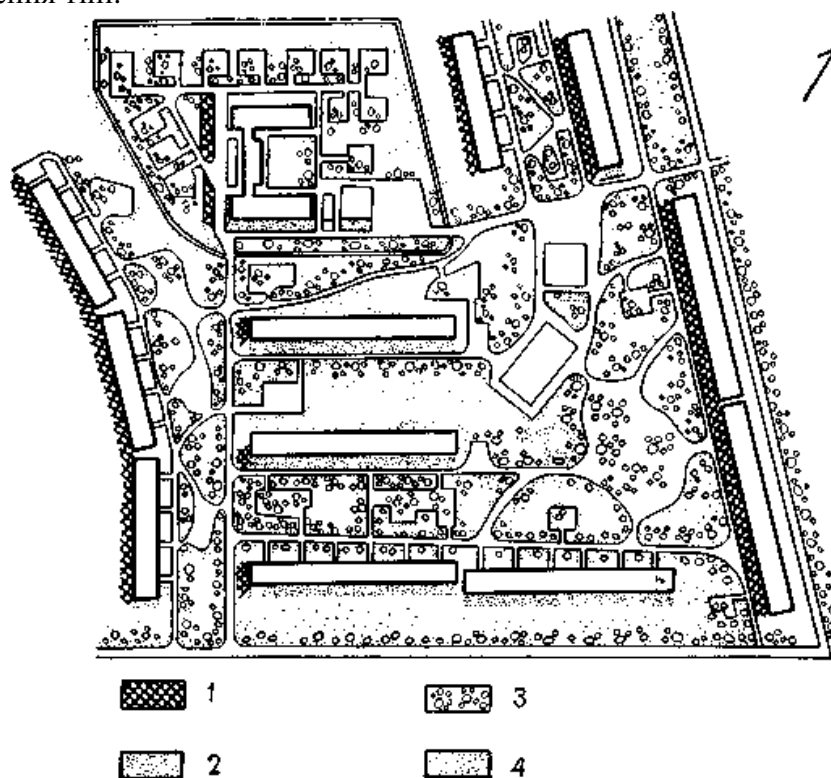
Схема розміщення зелених насаджень з урахуванням поліпшення мікроклімату: 1 — посадки, що захищають територію від теплового дії фасадів і приміщення від перегріву; 2 — посадки, що знижують теплову дію фасадів на прилеглу територію; 3 — посадки для захисту доріжок і майданчиків від інсоляції; 4 — посадки для захисту ґрунту від інсоляції
